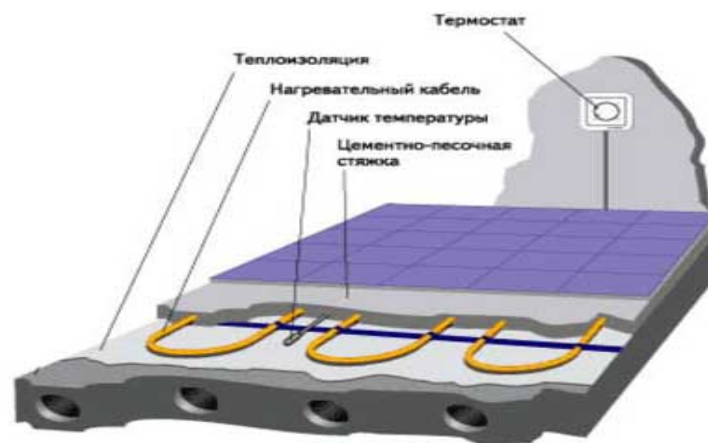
Тепла підлога із елементом нагрівальної панелі
